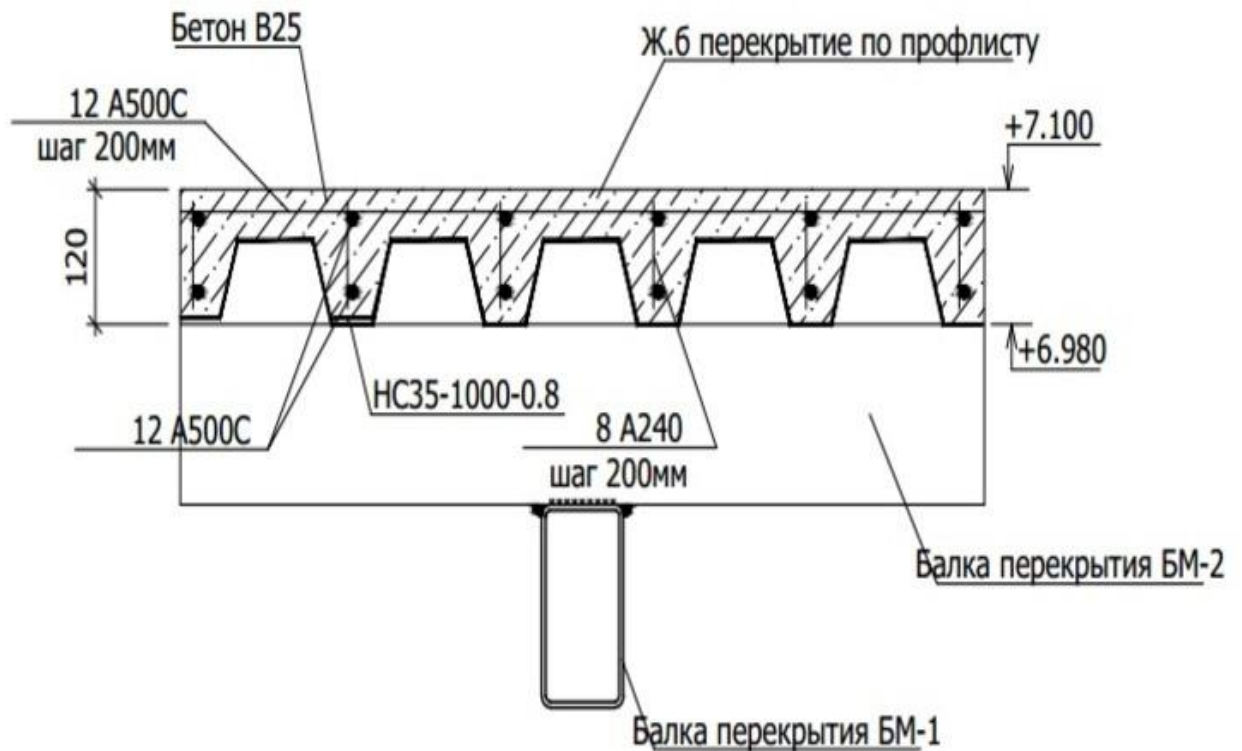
Вариант армирования монолитного бетонного перекрытия по профлисту
